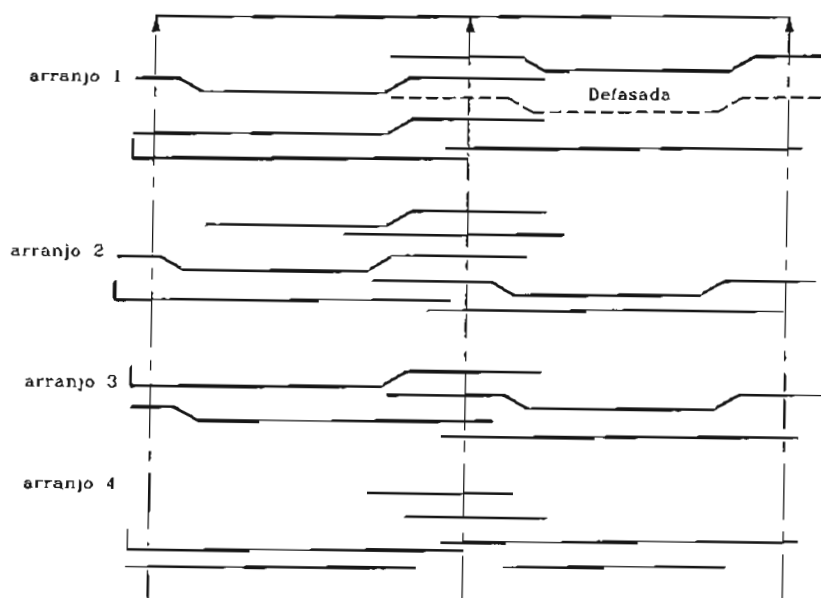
Arranjos de armaduras possíveis para lajes contínuas
